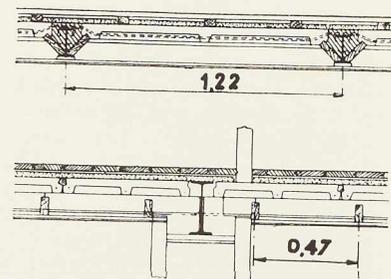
Coupes longitudinale et transversale d'un élément de plancher.
